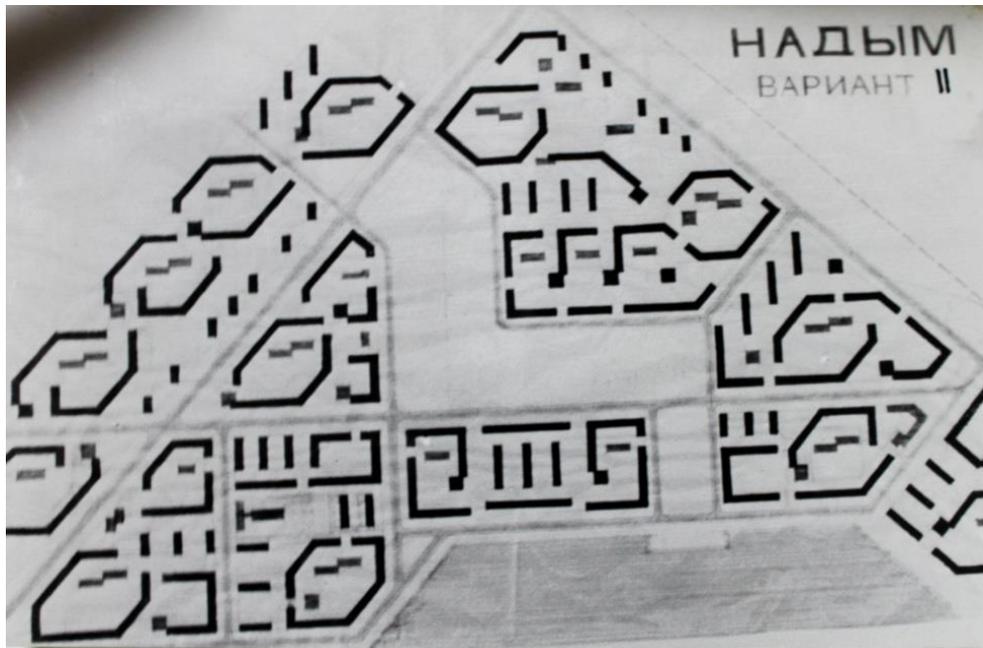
Проектное предложение к разработке генерального плана Надыма
